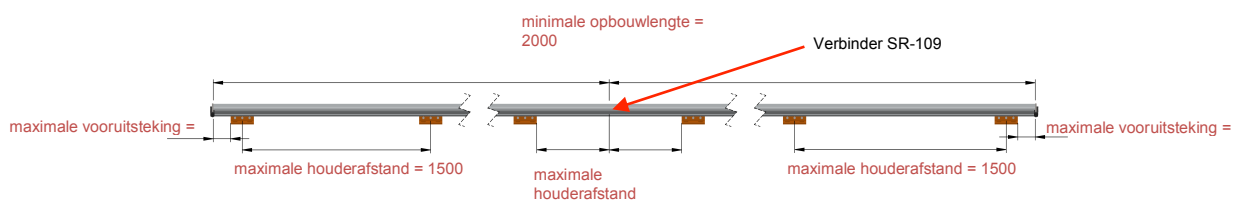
Schematische opbouw Rope Access afzonderlijke rail
